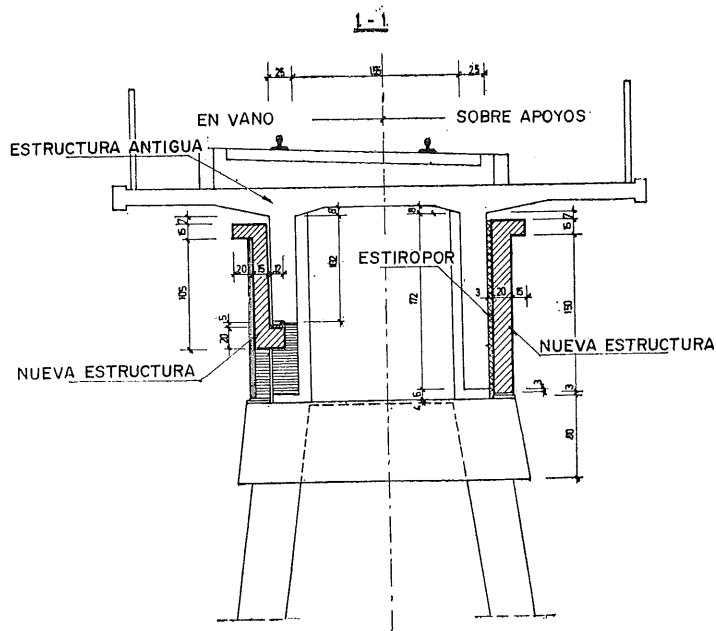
Sección transversal del puente de ferrocarril en la línea Petrovaradin-Beocin.
